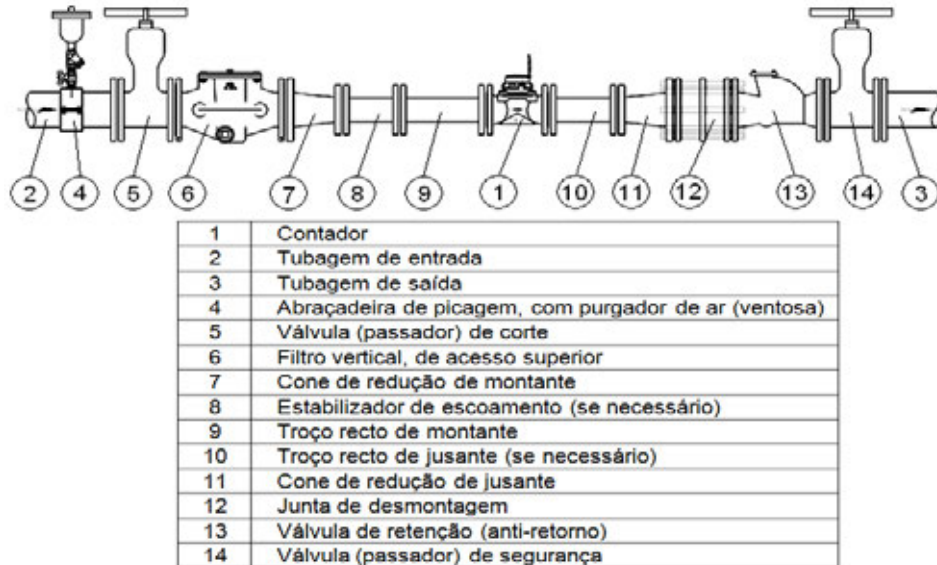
Condições que poderão ser necessárias para a instalação de um grande contador
